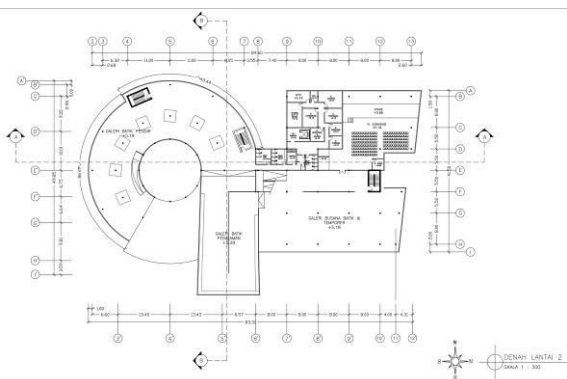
Denah Layoutplan. Sumber: penulis.
